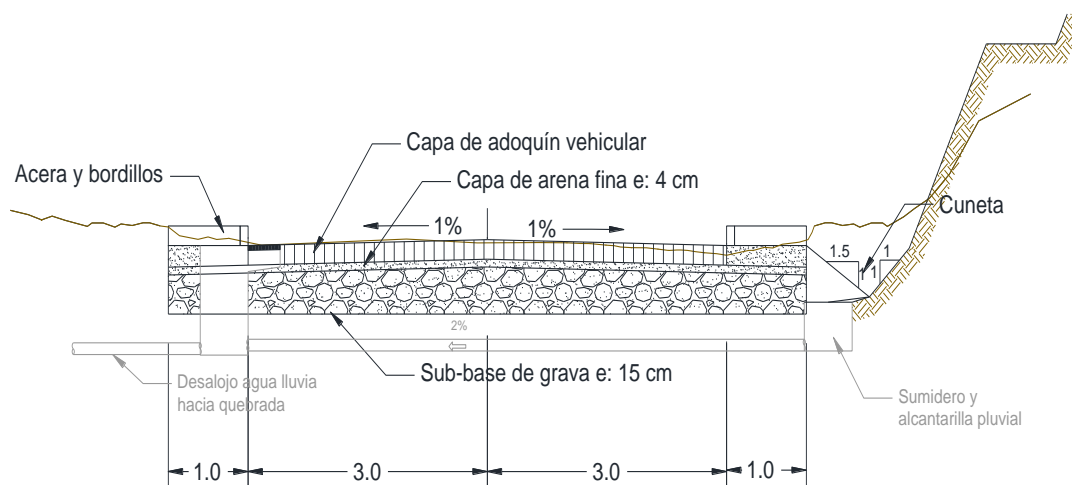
Sección transversal tipo adoquinado de vía Av. Atahualpa
